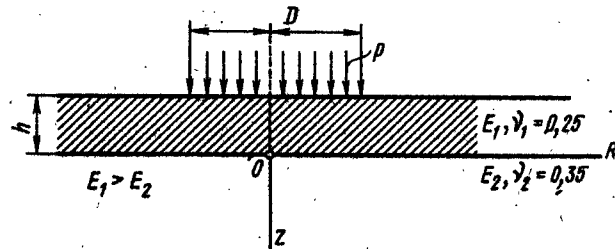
Расчетная схема к определению напряжений в двухслойных системах от нагрузки, передающейся через площадь круга
